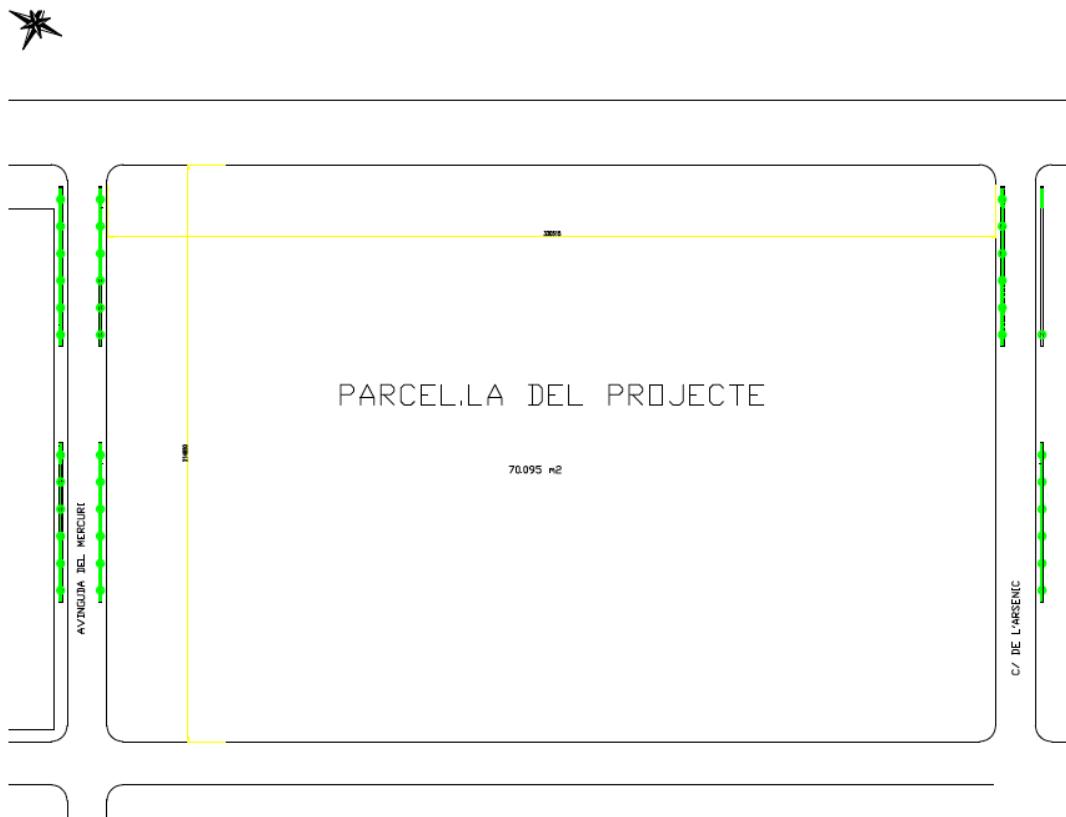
Parcela disponible para la construcción de la planta de Acetaldehído.
